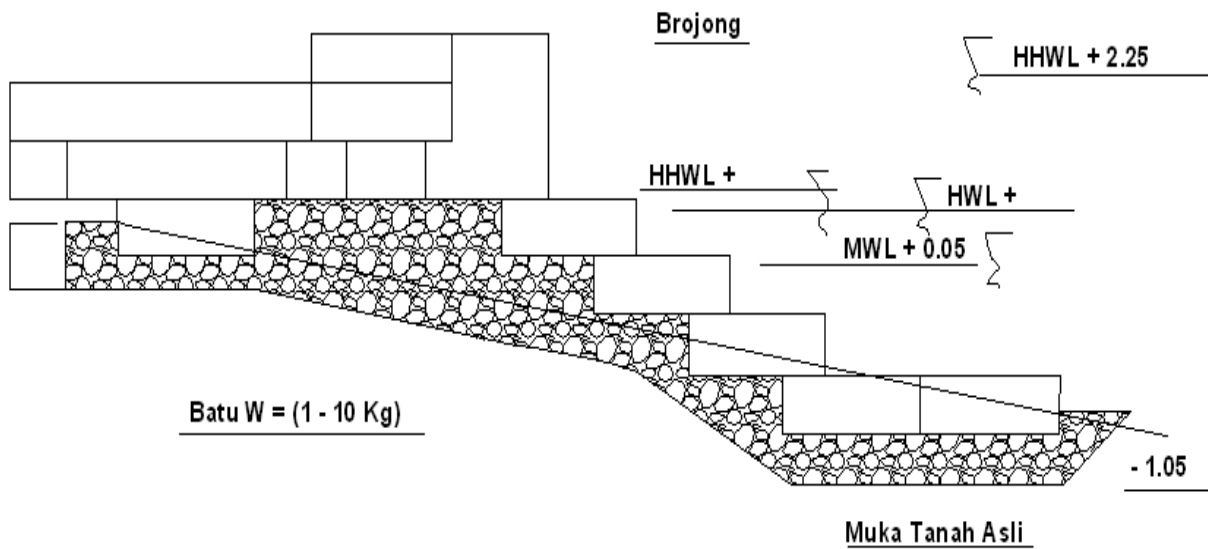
Revetmen dari plat beton bergigi
